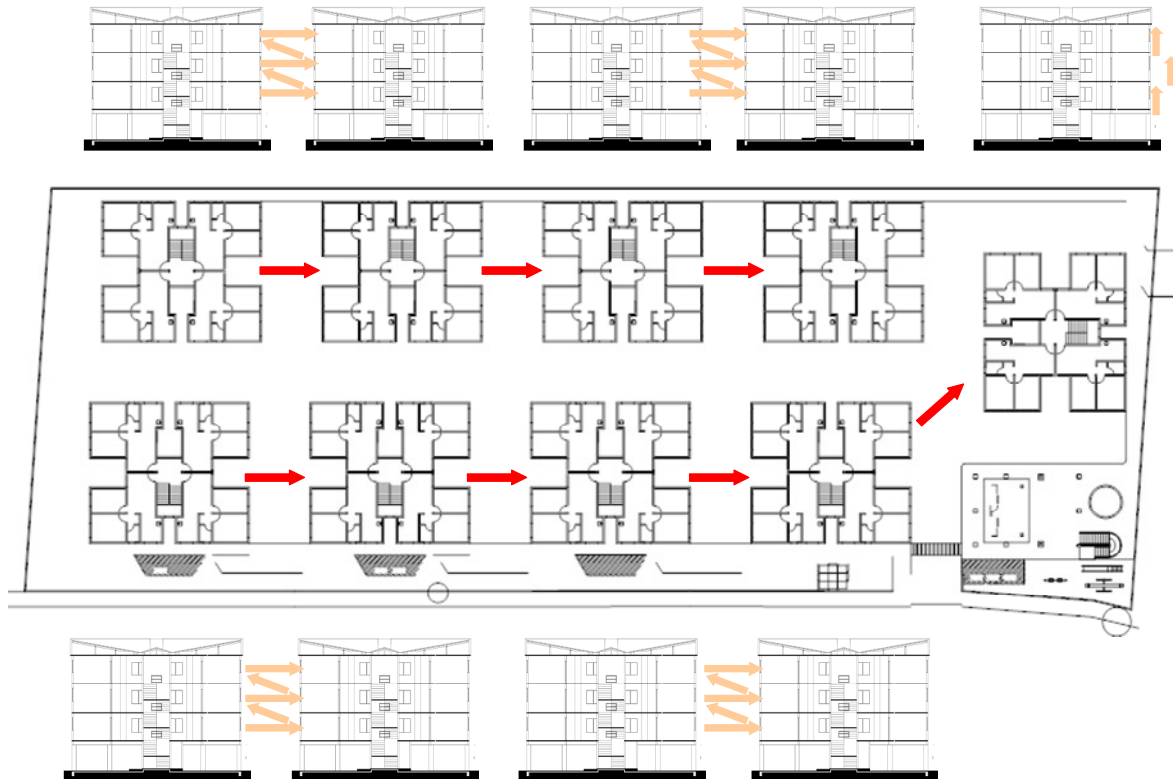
Ordem de ataque dos blocos na fase de alvenaria estrutural e lajes (estrutura dos pavimentos)
